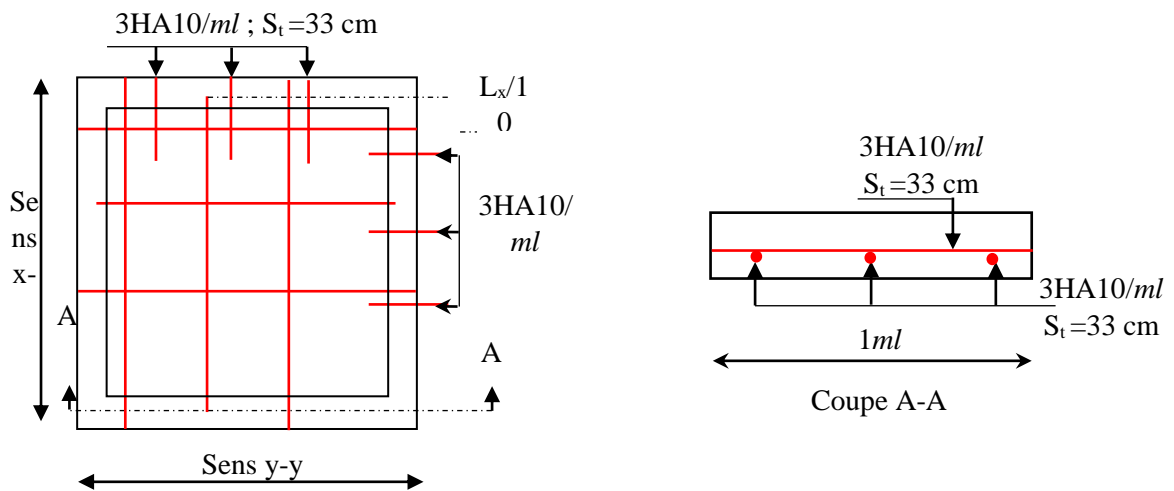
Schéma de ferrailage de la dalle pleine au-dessous de l'ascenseur
